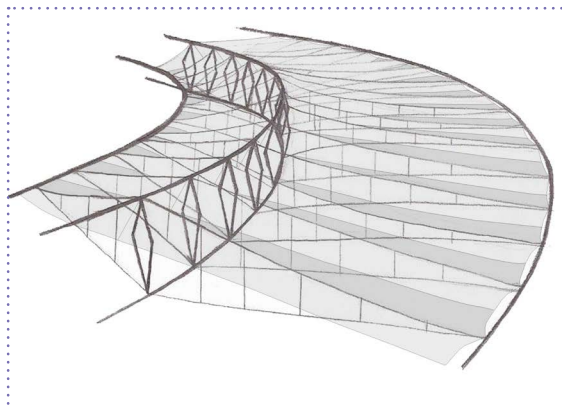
Aspecto exterior de la cubierta del estadio Maracanã
